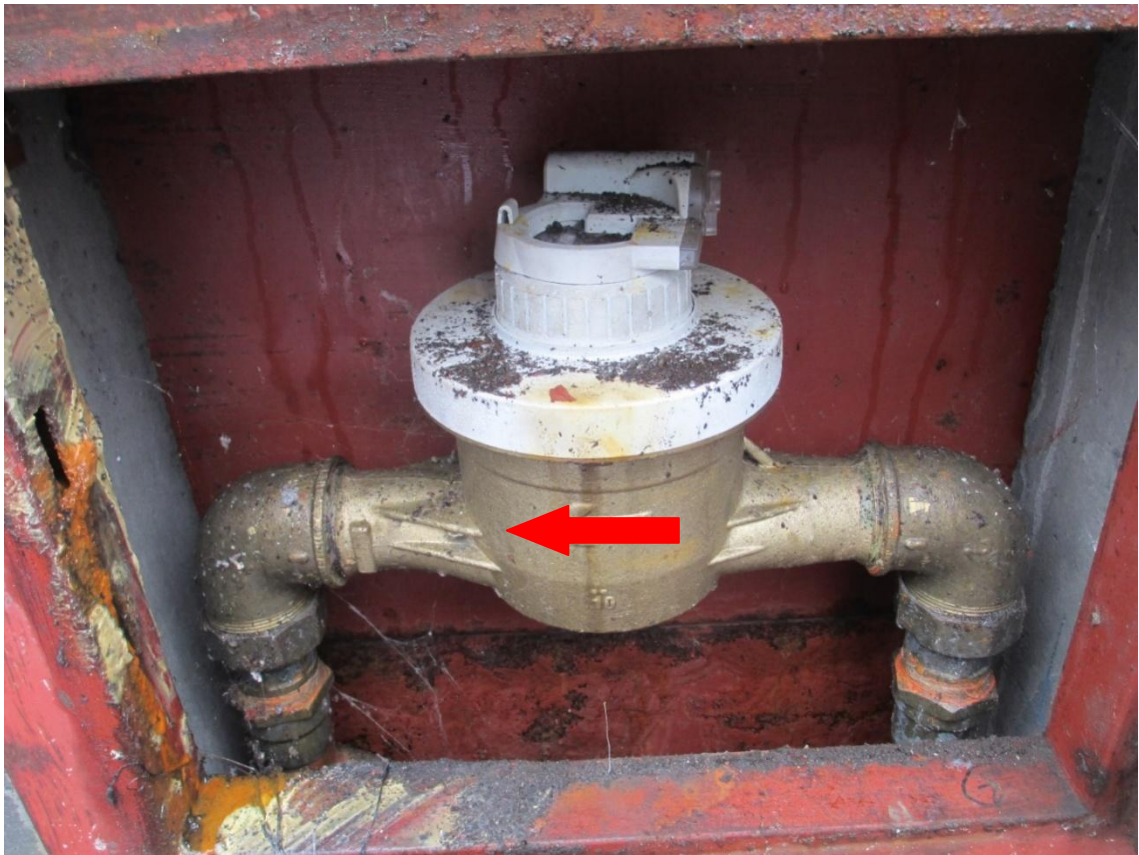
Foto de la instalación original del contador en M4 (Fábrica), B.
